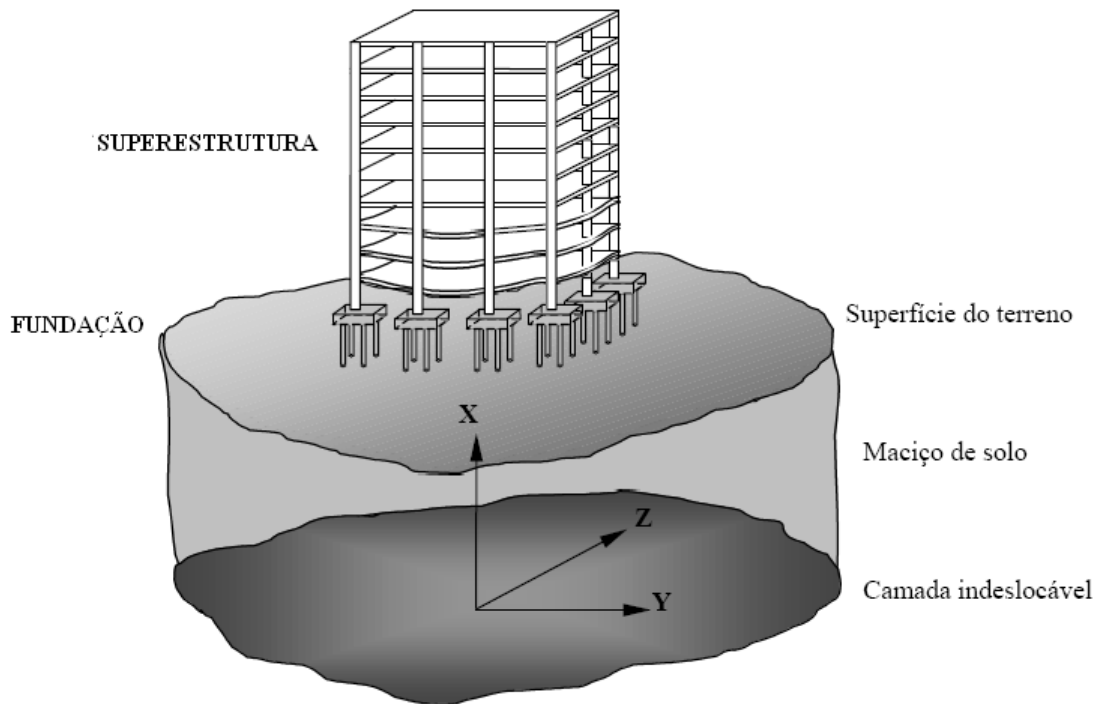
Sistema estrutural e sistema geotécnico.
